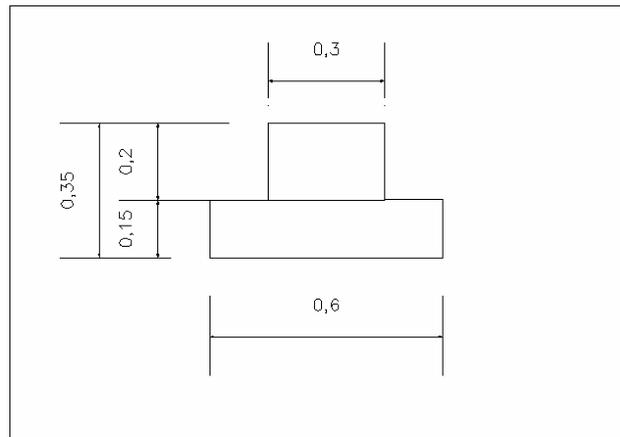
Dimensiones Zapata corrida para vivienda con estructura de caña y madera
